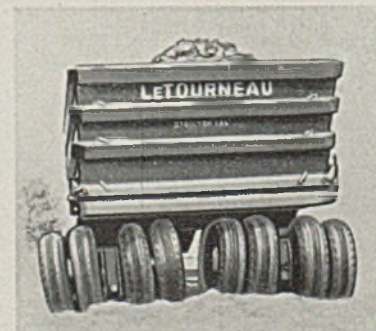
22 m³-Erdtransportwagen mit Schwingenlagerung der Gummiräder.
